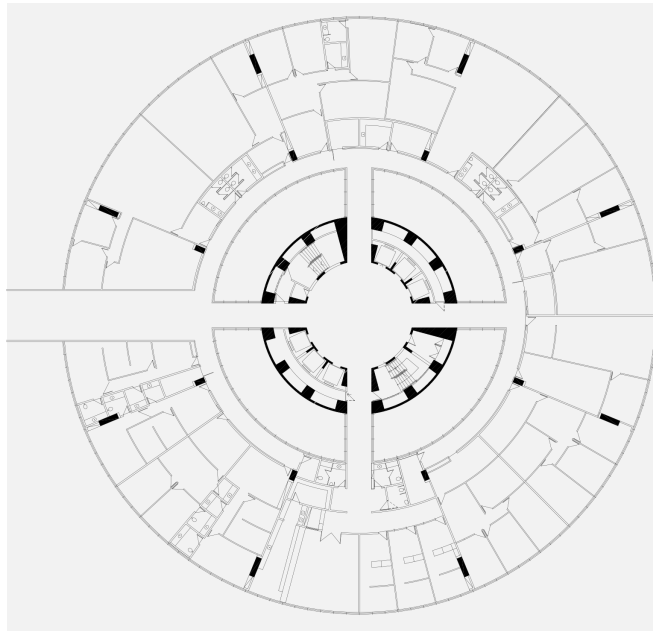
Planta do pavimento tipo, bloco B; Fonte: Arquivo da PGR
